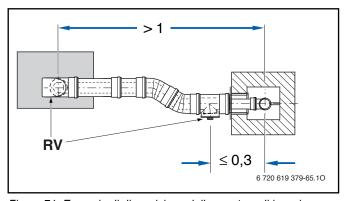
Esempio di disposizione delle aperture di ispezione per un condotto fumi con deviazione in locale di posa – vista dall'alto (quote in m)
